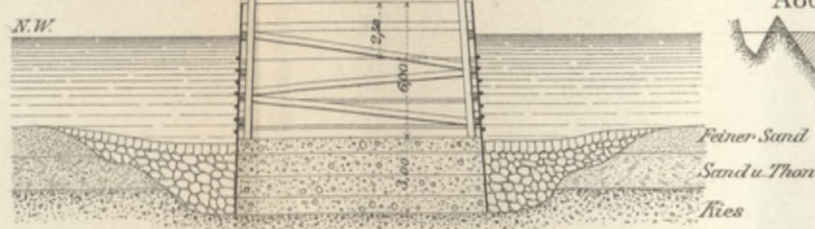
Eiserner Mantelkasten f.d. Pfeilergründung der Donaubrücke bei Gutenstein.
